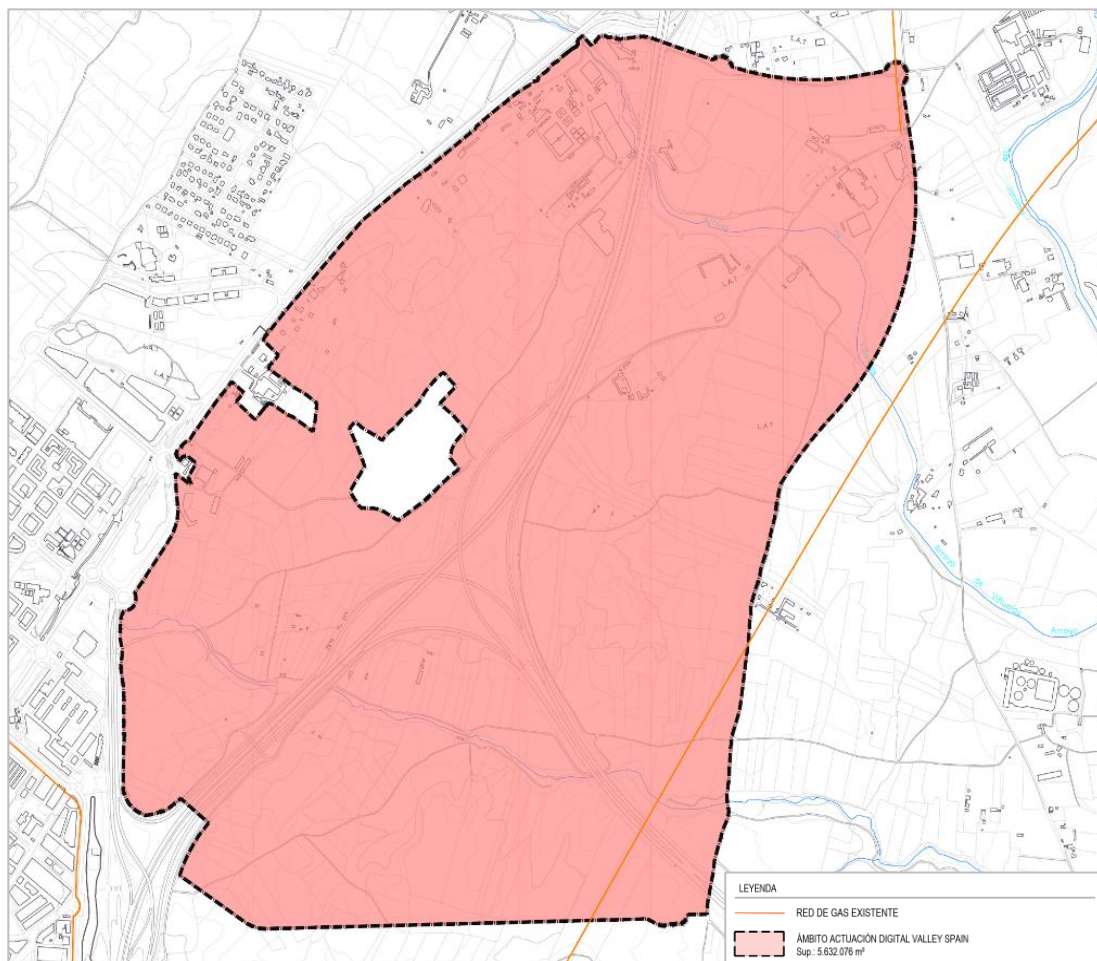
Plano Red General de Infraestructuras. Red enterrada de gas
